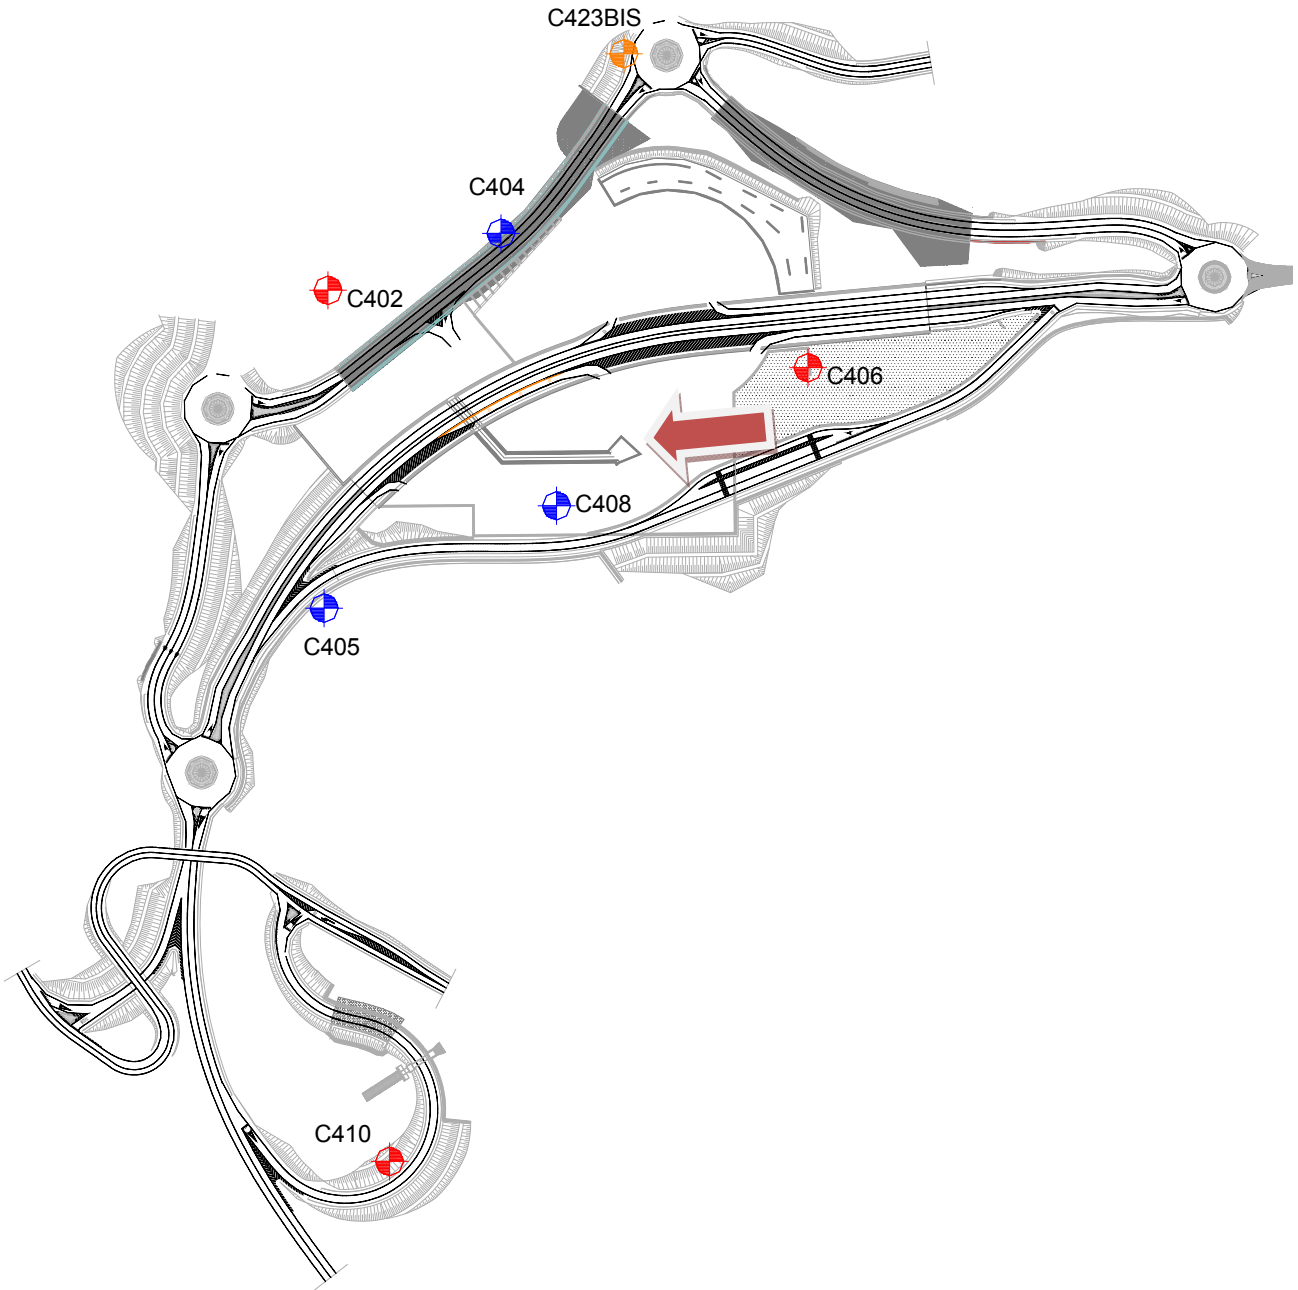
Stralcio planimetrico con ubicazione delle opere e dei sondaggi
